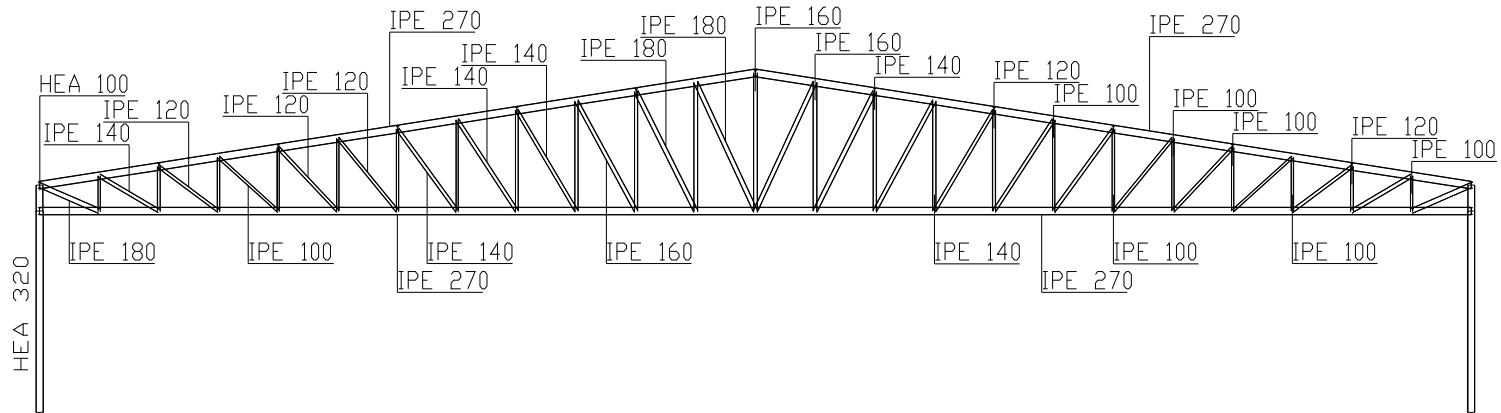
Pórtico com pilar de alma cheia, viga em treliça, vão de 60.00m, pilar em perfil com secção transversal HEA, viga em perfil com secção transversal IPE.
